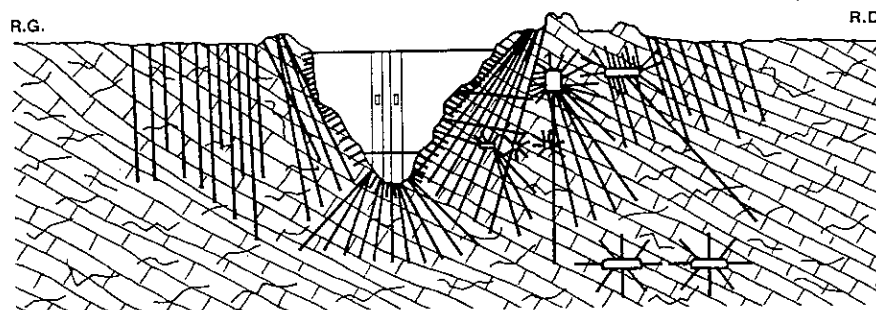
Barrage voûte, voile d'étanchéité (doc. Solétanche)
